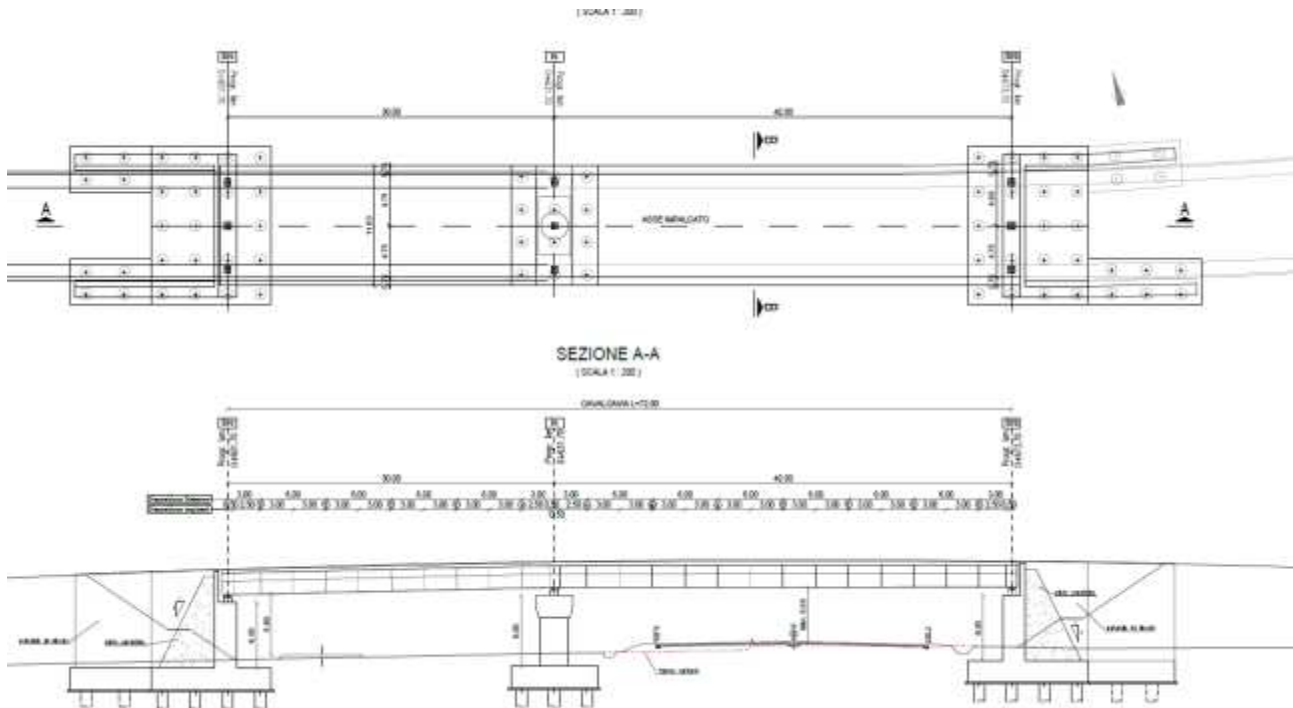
Pianta e Sezione Cavalcavia al Km 5+540
